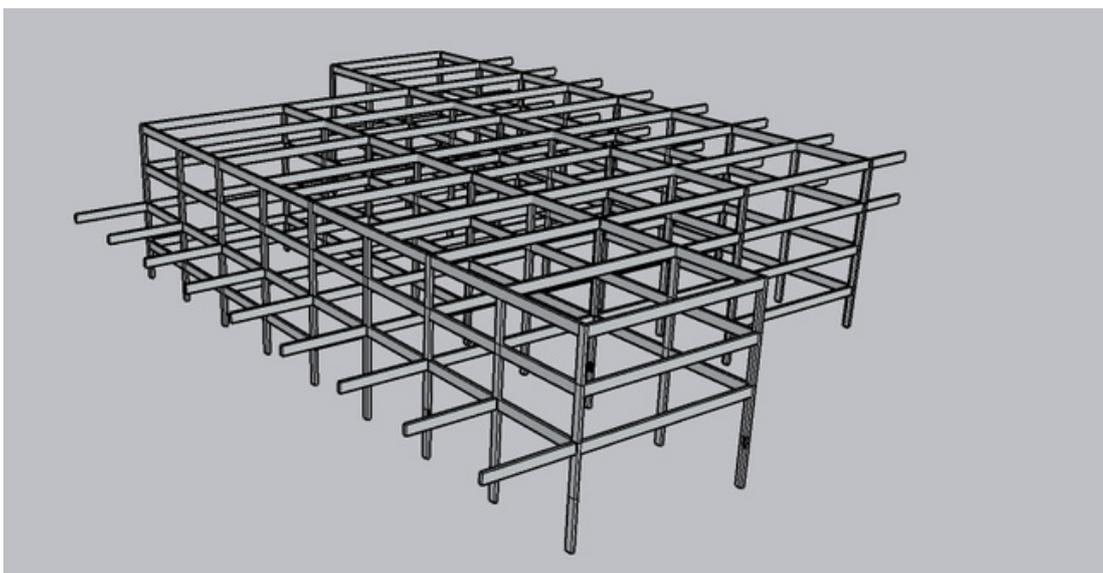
Visão 3D da estrutura. Fonte: Elaborado pelo autor
